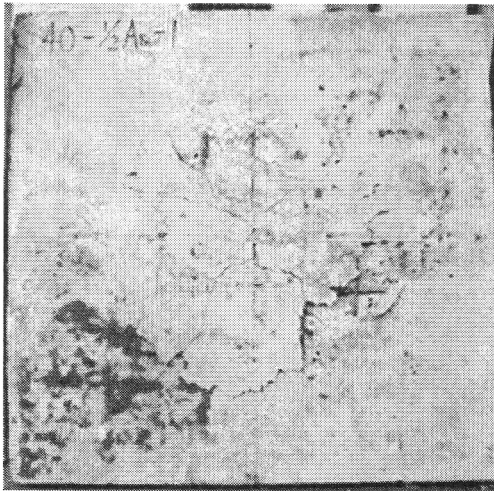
床版のひび割れ状況(40-1/2As-1)
